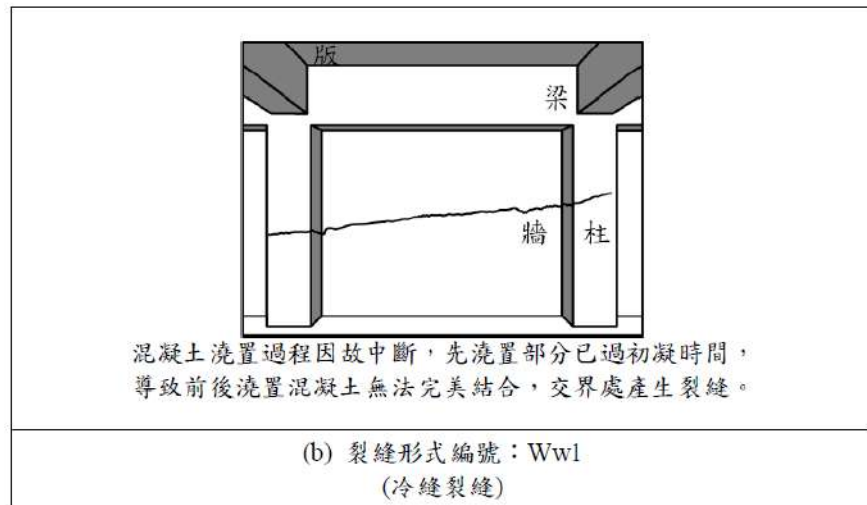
RC 結構牆施工不良之裂縫示意圖[2.1]
